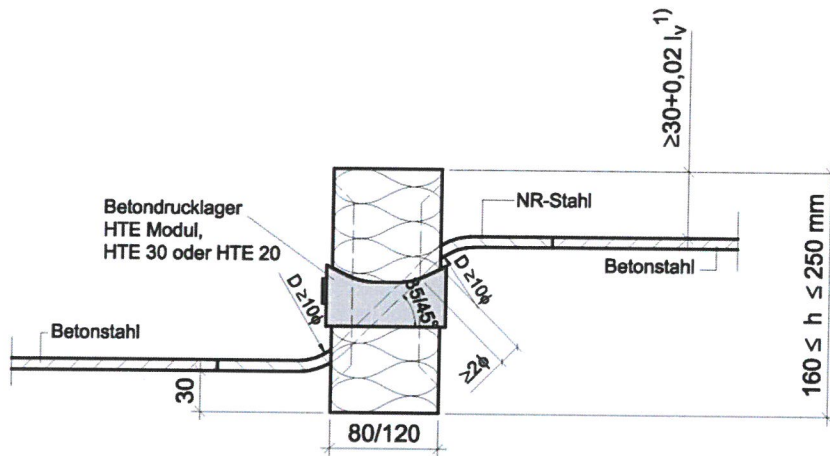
Schöck Isokorb Typ RQ-240 mit Betondrucklager
